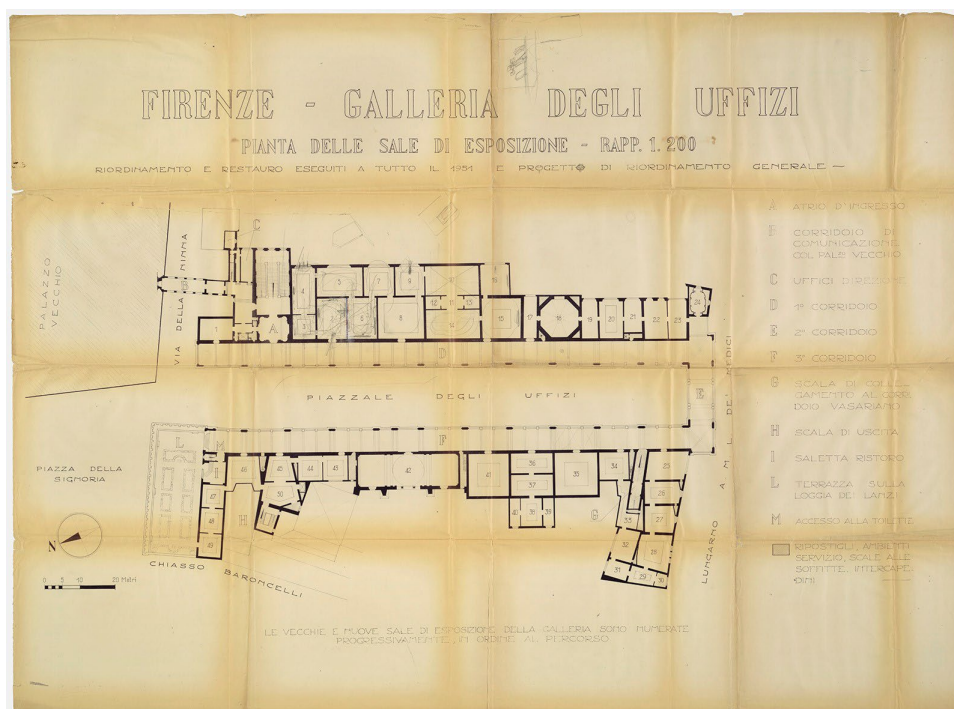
Planimetria generale della Galleria degli Uffizi, riordinamento e restauro compiuti fino al 1951 e progetto di riordinamento generale, scala di rappresentazione 1:200, eliocopia, n. 052569, MAXXI, Scarpa-1.PRO/1/149 - CASS.24.3, Progetti e incarichi professionali.
